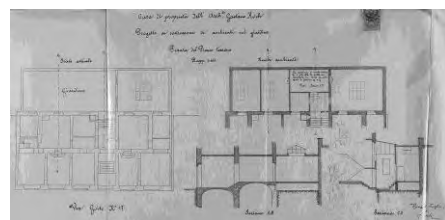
casa di Proprietà Koch nuovo ampliamento pianta e sezione
